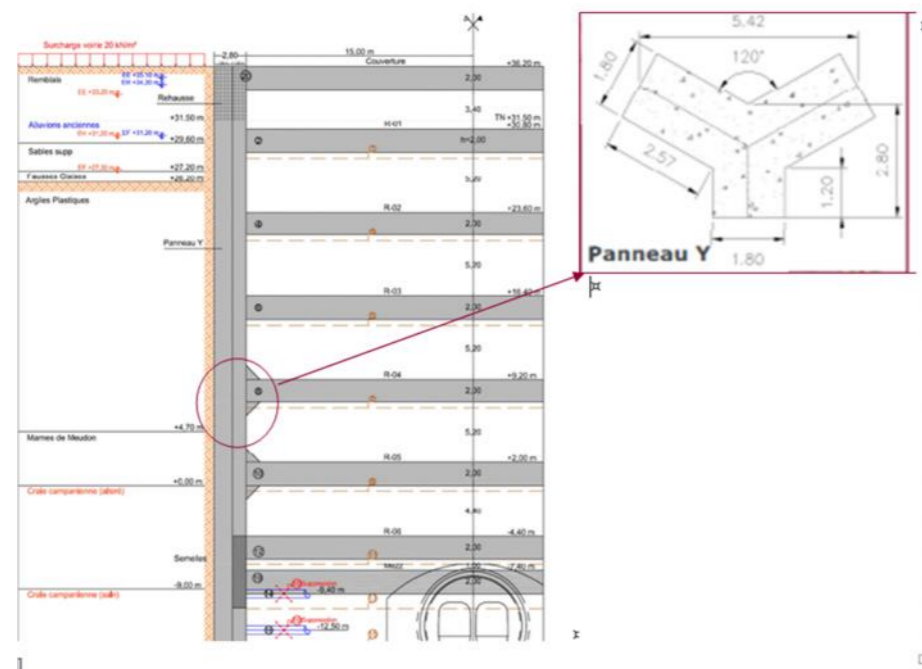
Coupe du puits central et mise en évidence de l'empattement du panneau en Y
